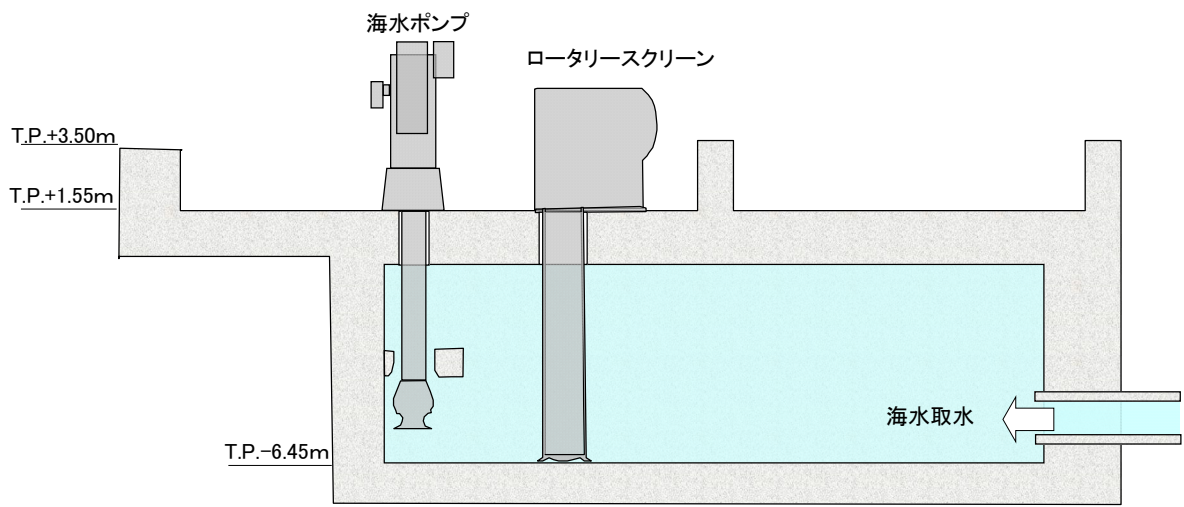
3, 4号炉海水取水設備 (断面図)
